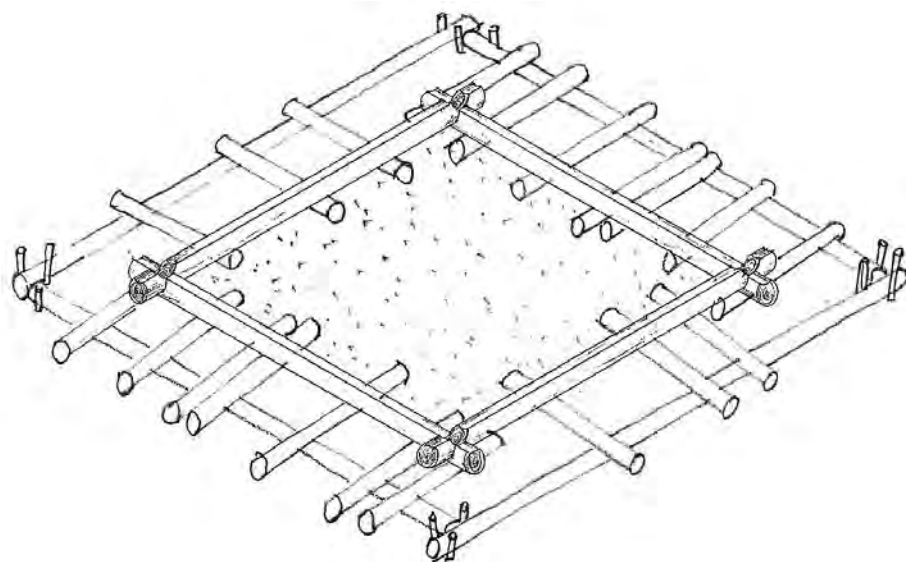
Сруб на планировочной площадке и на подкладках, соединенных с обвязкой площадки
